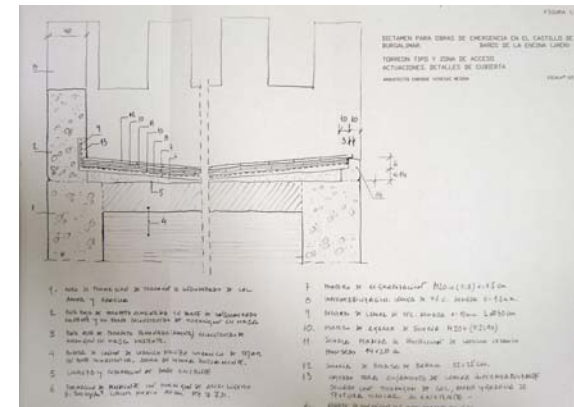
Detalle del proyecto con la propuesta de actuación en las cubiertas. Expediente A97.0050E.23BC del archivo de la Consejería de Cultura de la Junta de Andalucía.
